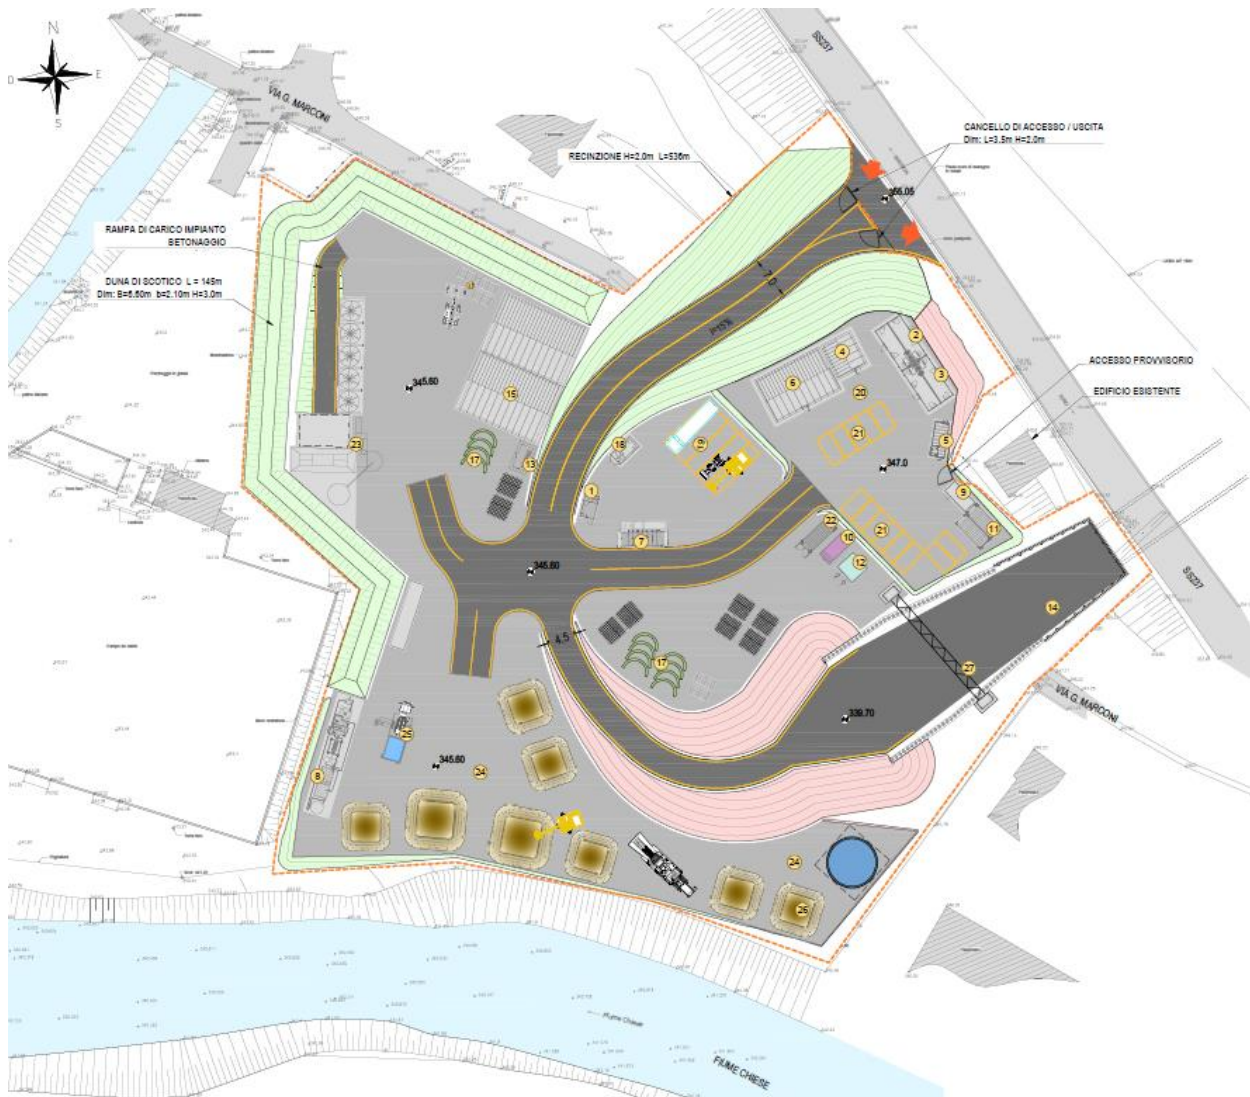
Planimetria dell'area cantiere zona sbocco galleria – Fase 1 Realizzazione opera di imbocco e galleria
